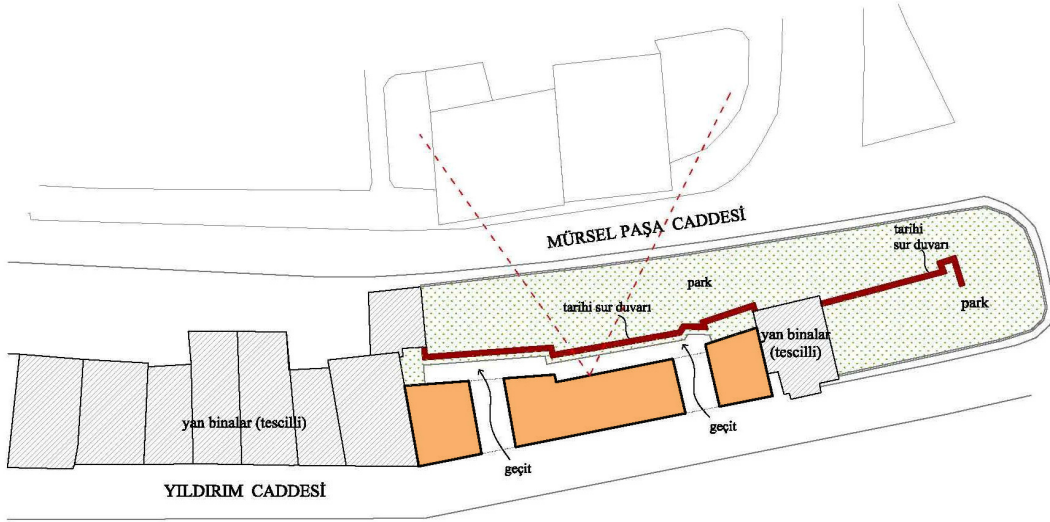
'de yeni yapı önerisinin bulunduğu vaziyet planı görülmektedir. Şekil6.9'da ise 1. öneriye ait plan, kesit ve görünüş çizimleri yer almaktadır.
